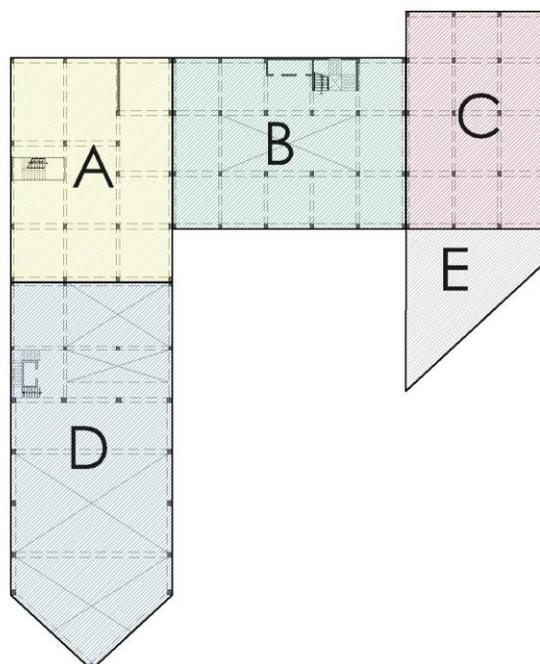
Esquema de división por bloques. Fuente: Elaboración propia.
